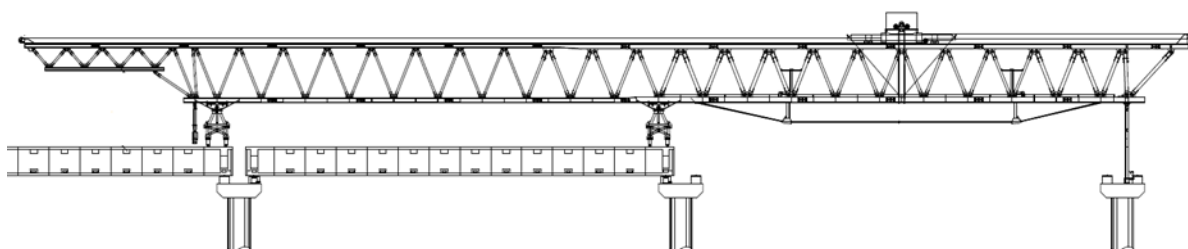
Lançadeira em posição para colocação das aduelas (BERD, 2013b)
